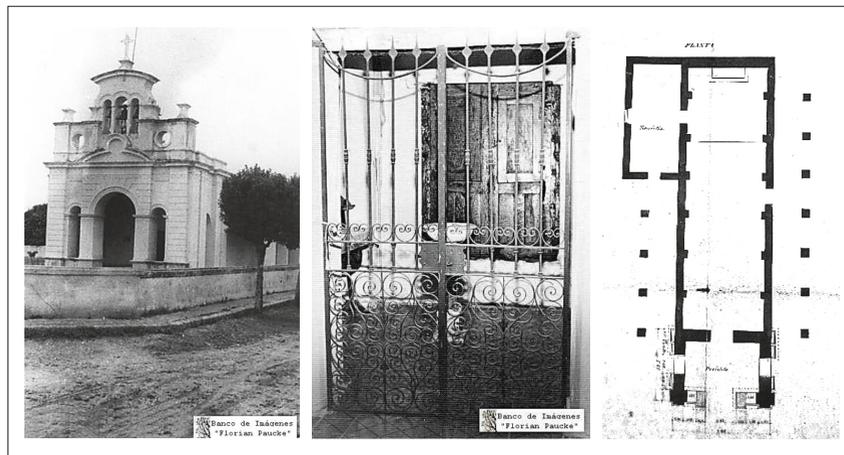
Capilla de Rincón. De izq. a der.: fachada; reja baptisterio (Fotog. 1970); planta capilla original, plano de Lomello, 1895
